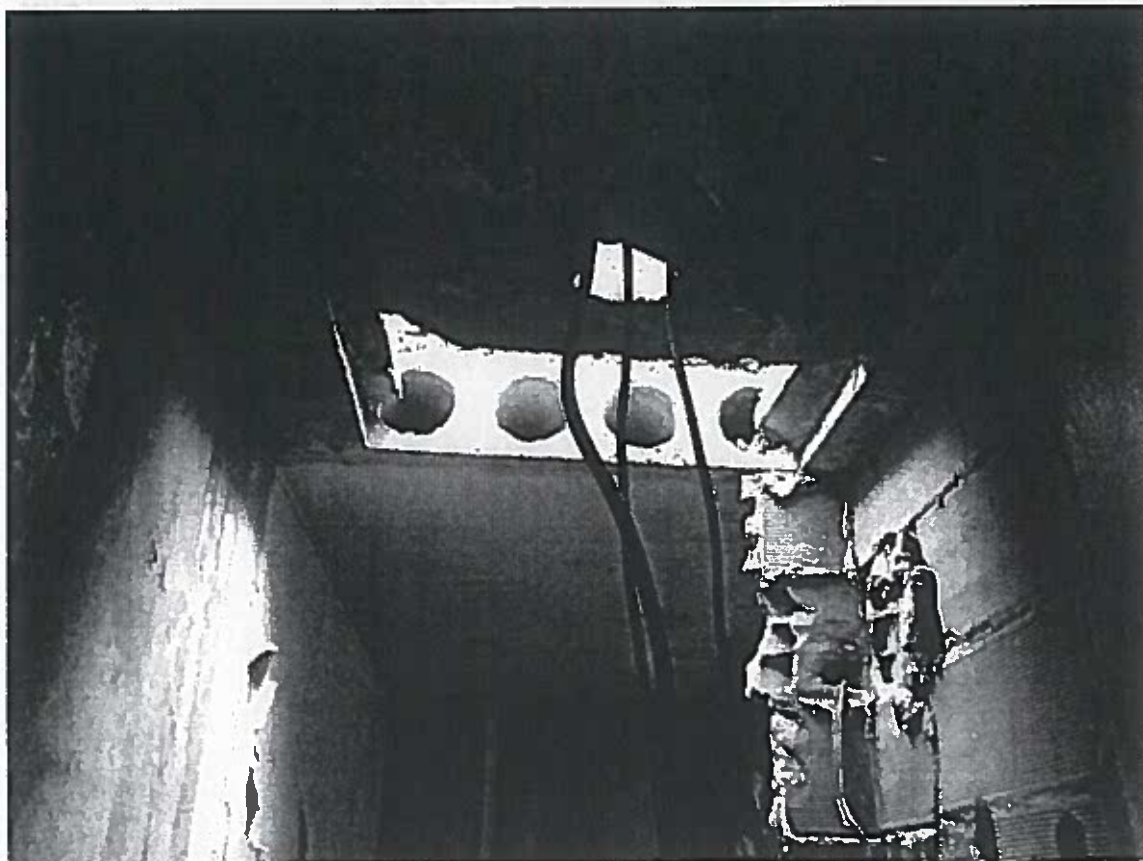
Instalace i dělicí příčky jsou poničeny
